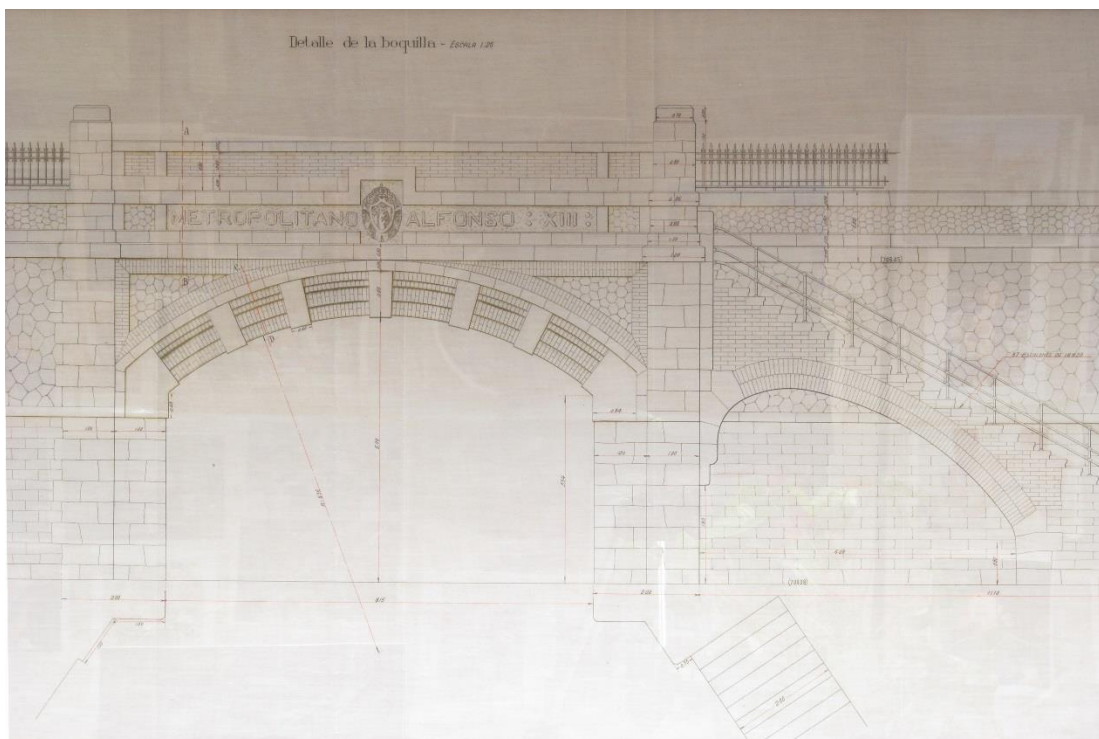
Alzado de la boquilla del túnel. Archivo Metro
